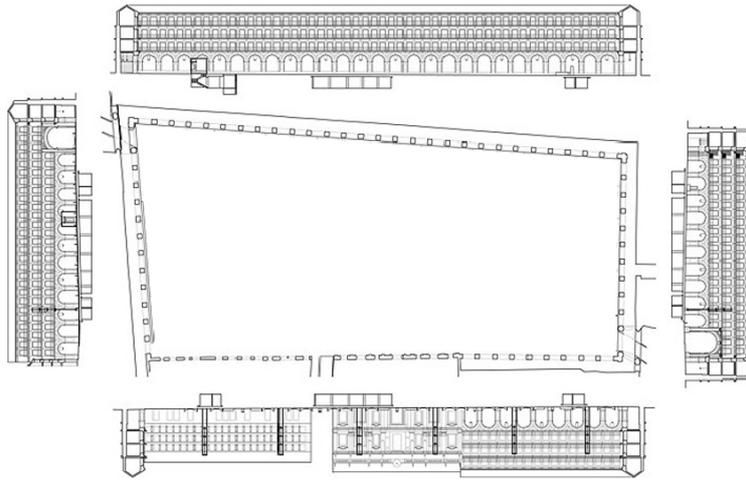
Plano de planta y alzados principales de la Plaza Mayor de La Corredera, en Córdoba.
